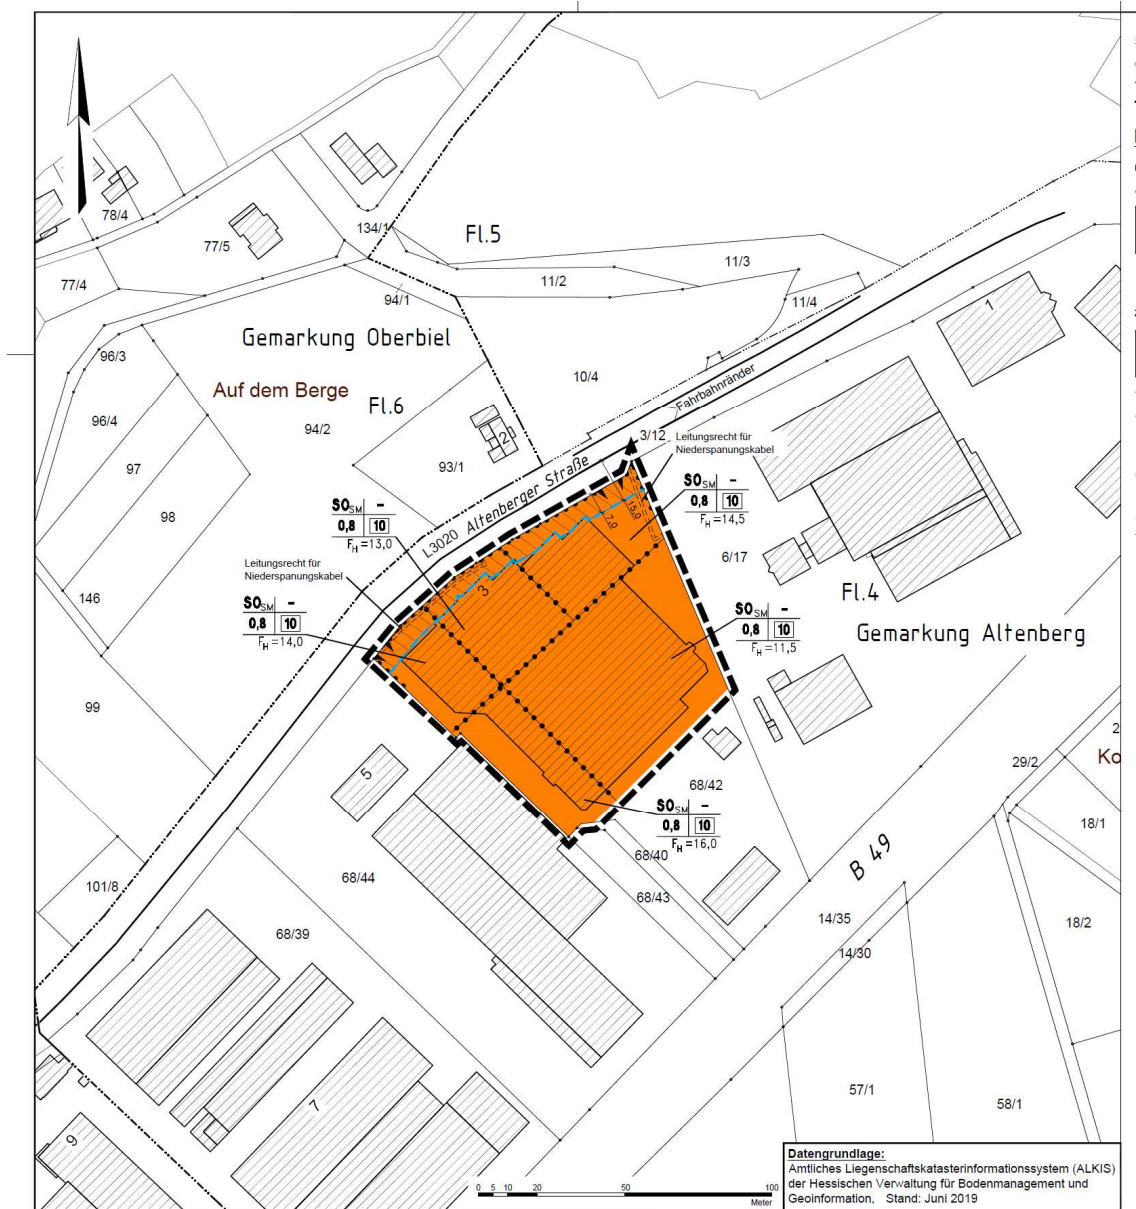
Bebauungsplan 5. Änderung des Bebauungsplans "Oberbiel-Ost", Planteil.
